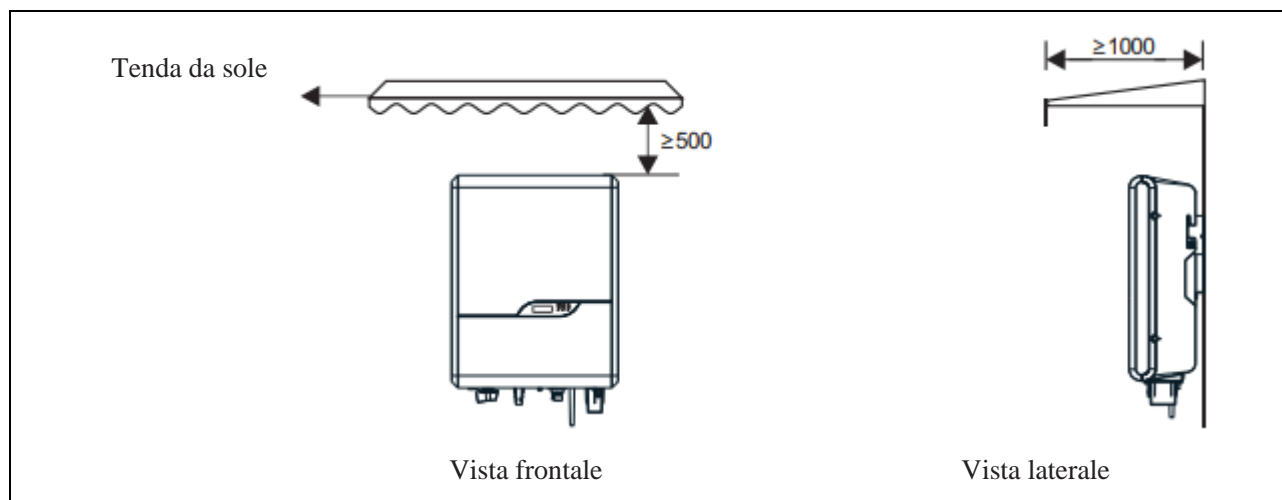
Ambiente di installazione con tenda (unità: mm).
